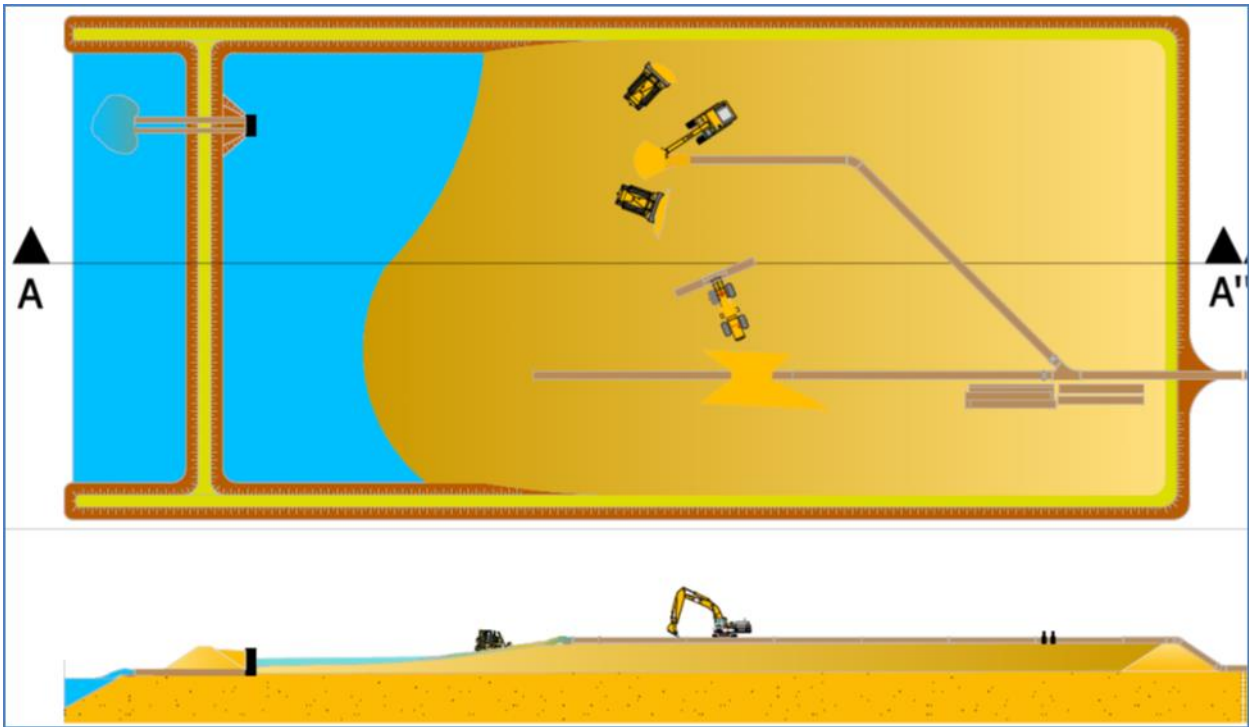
Vista típica y sección transversal de un croquis de bordos, tubería, bulldozers, excavadora y caja vertedero en un área cerrada de reclamación.
